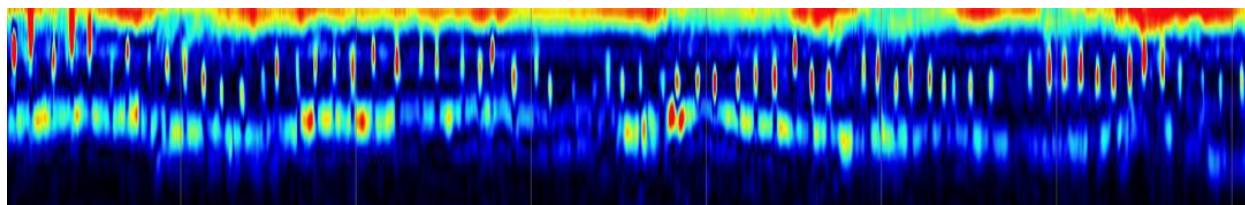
Armarea transversală interceptată în grinda de beton armat peste stâlpii din axul B
